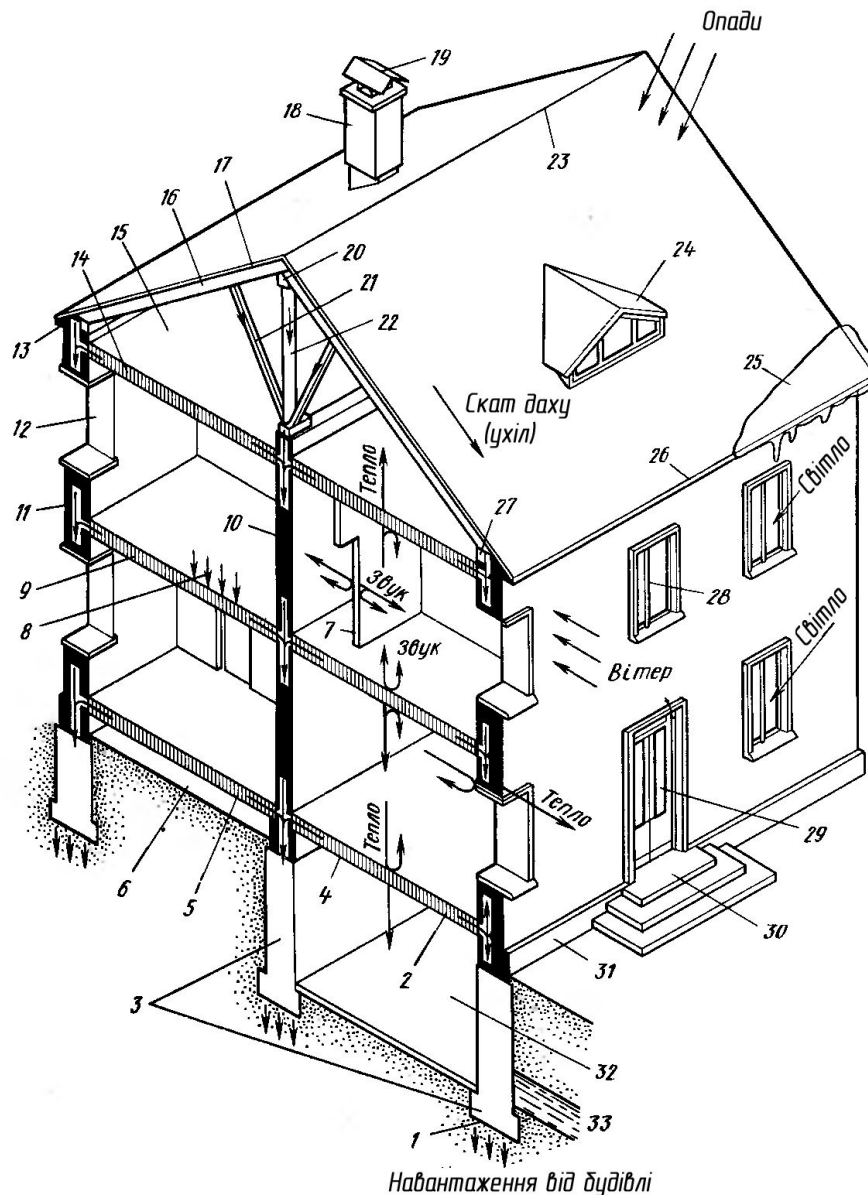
Основні конструктивні елементи будівлі із цегельними несучими стінами:
